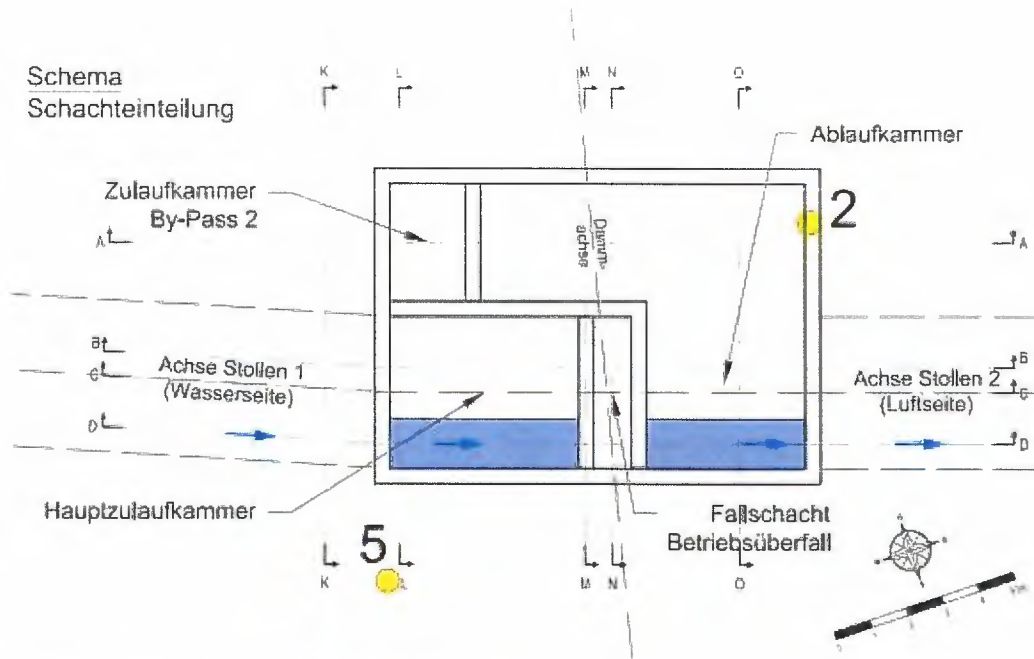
Schnitt Kontrollschacht; aus Plan 12.5.3
